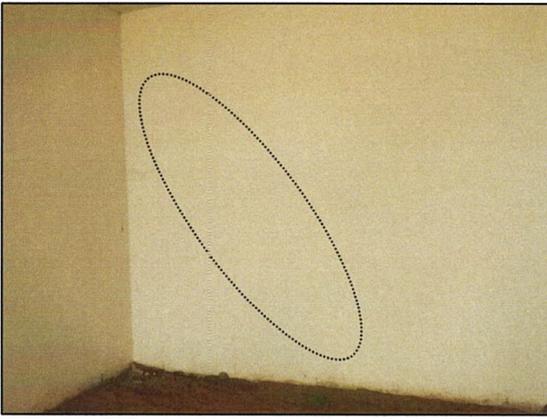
, fisuras en martelina de muros estructurales.
